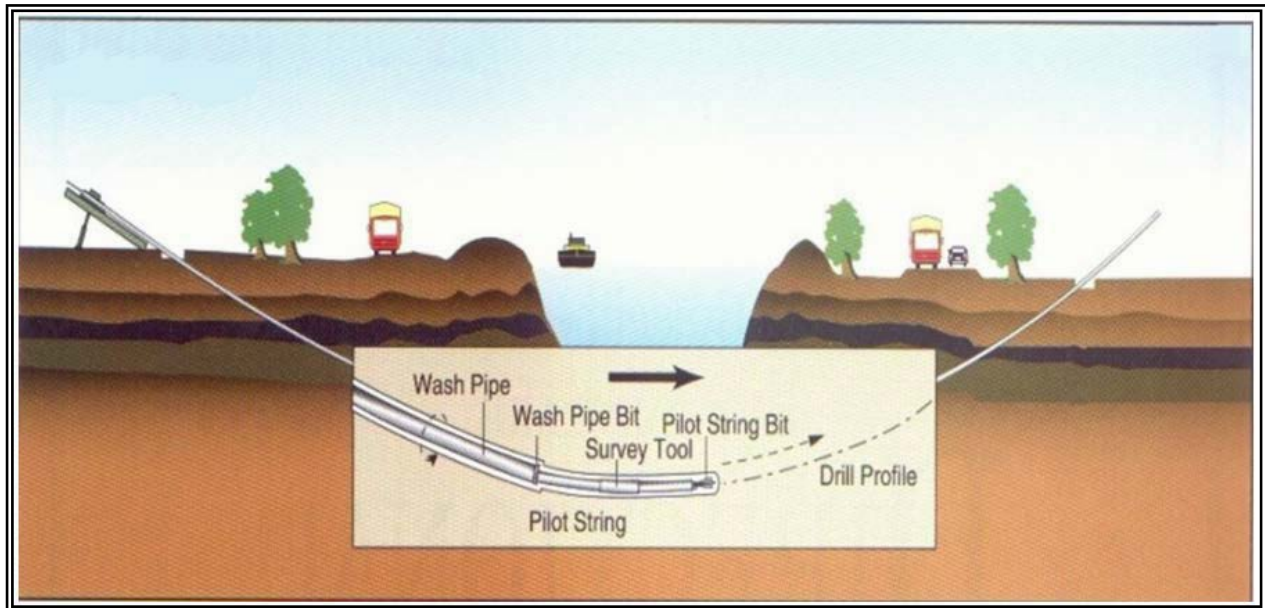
Técnica de perforación direccional empleada para colocar las tuberías de manera horizontal.
